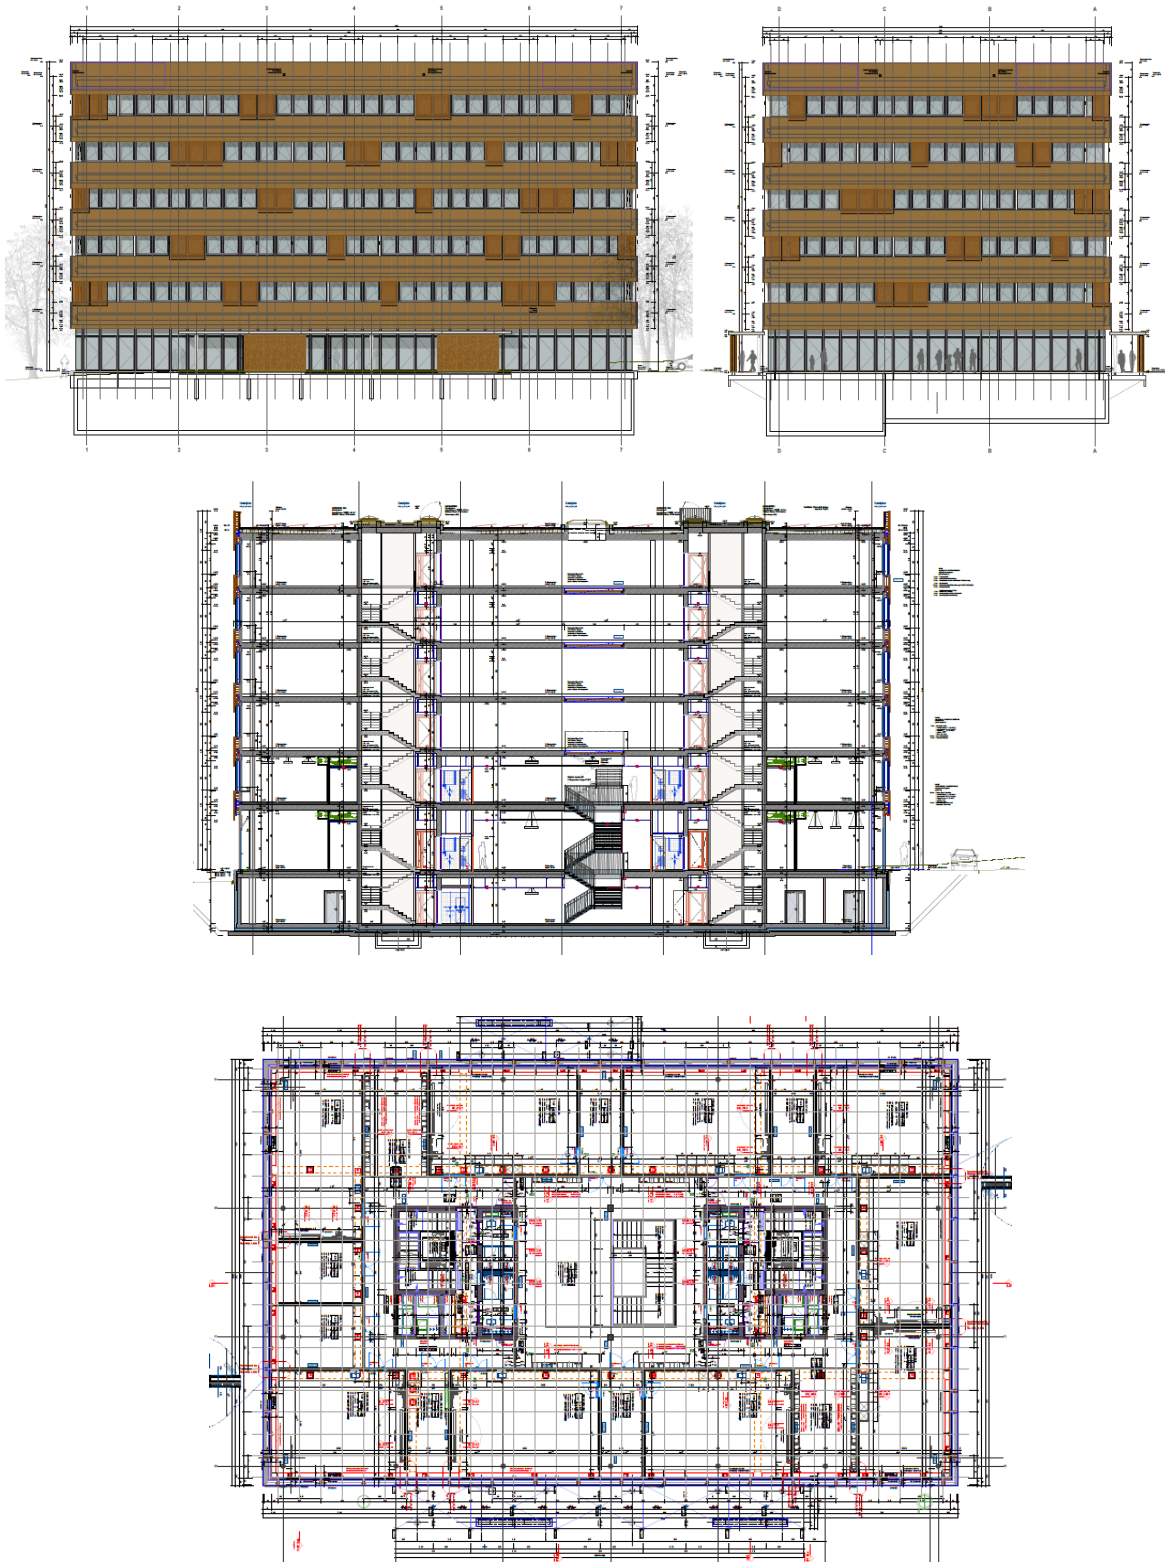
Planauswahl des Schul-/Bürogebäudes S41 der «Suurstoffi» an der HSLU Rotkreuz. Ost-/Nordfassade, Längsschnitt und Grundriss 1. Obergeschoss.
